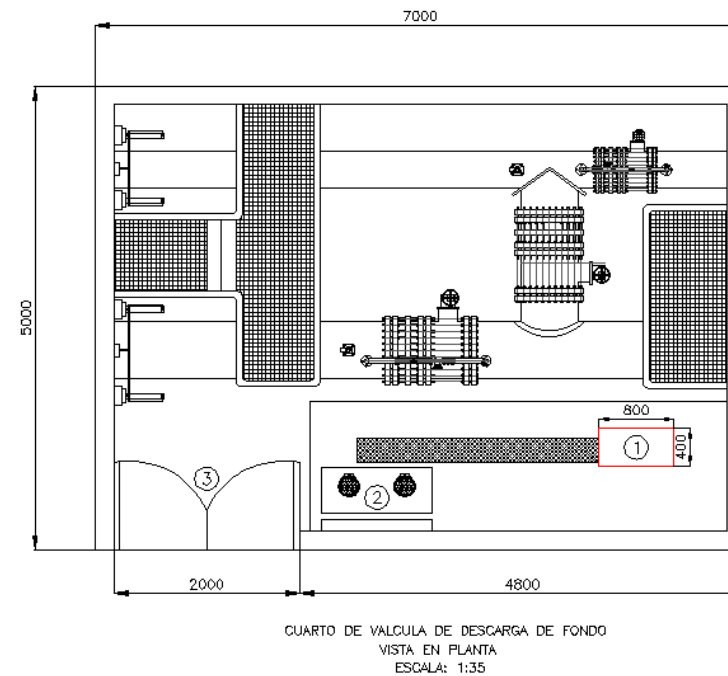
Plano de ubicación de tableros – Válvulas de descarga de fondo
